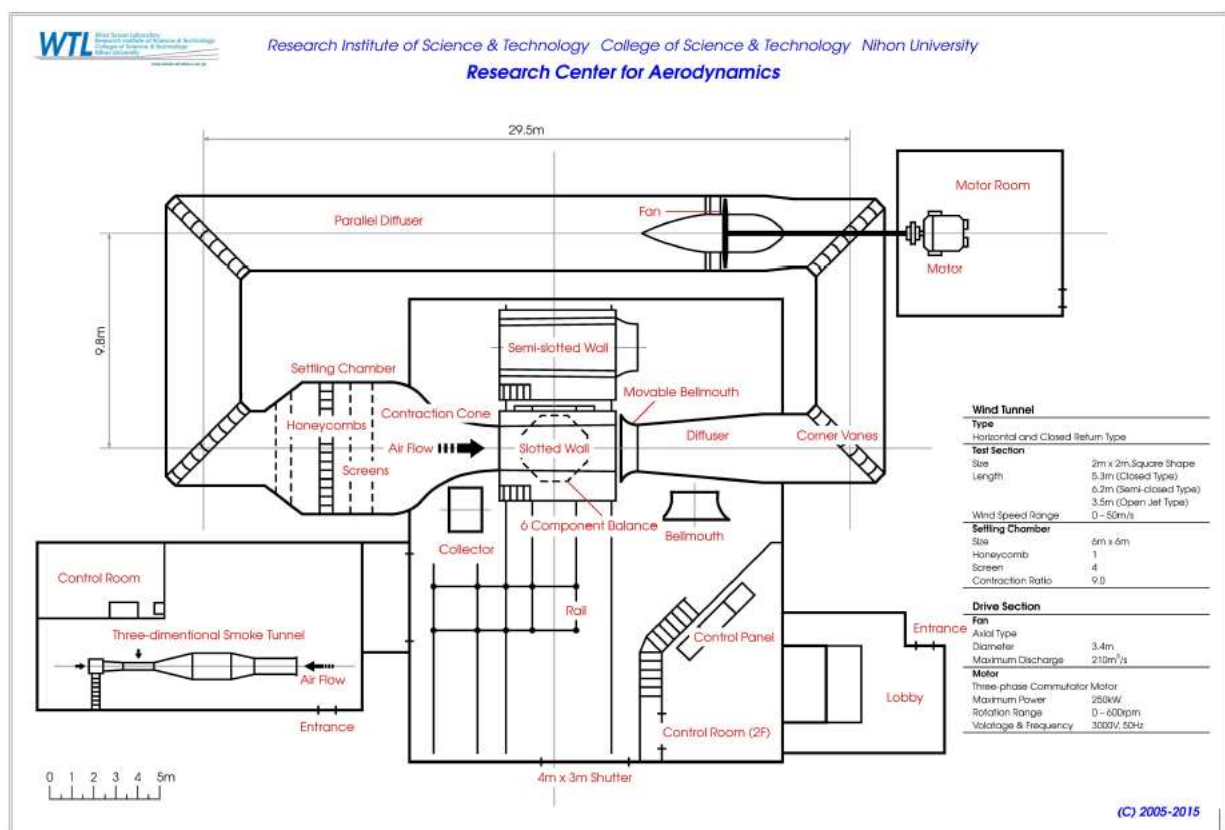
理工学研究所 空気力学研究センター 風洞実験室 平面図
